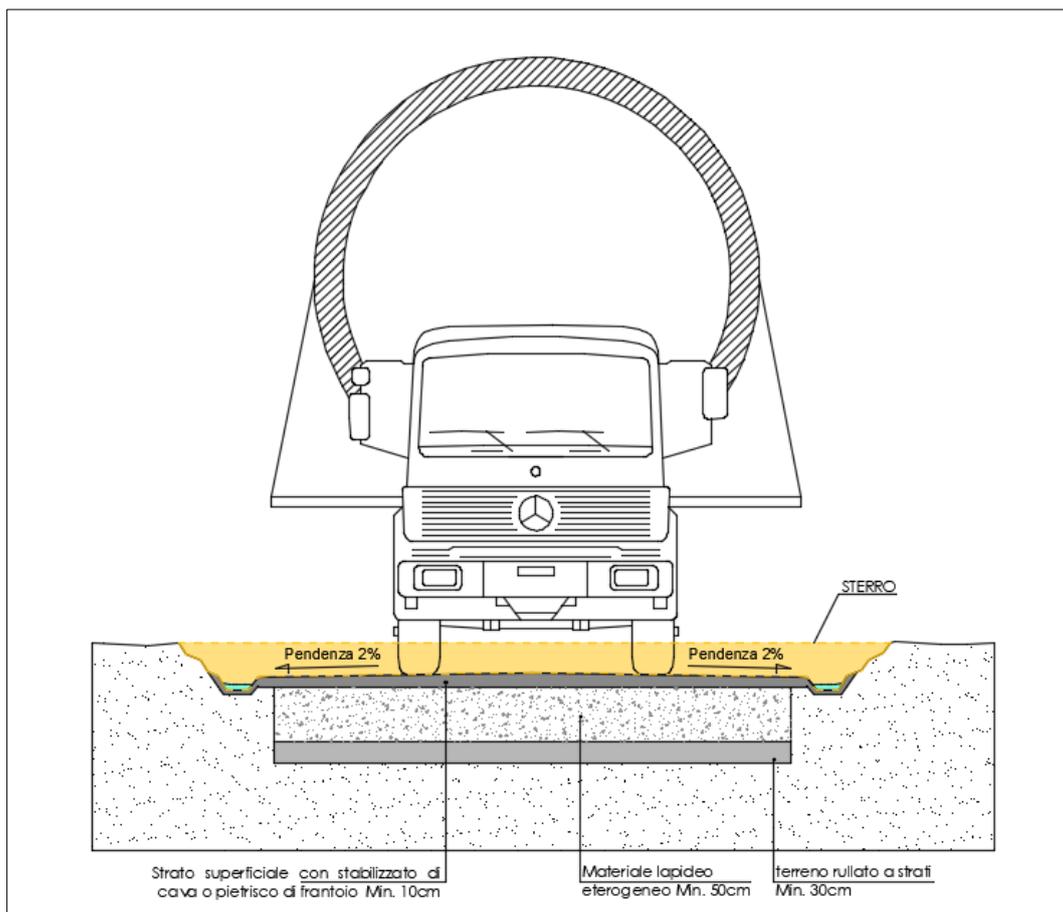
Sezione stradale tipo di nuova realizzazione in trincea
